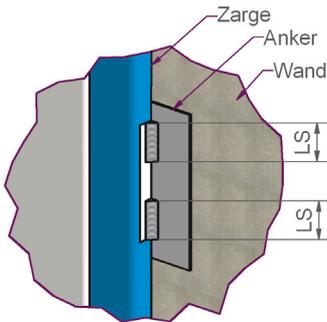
Schweißnähte an der Zarge (Beispiel)
